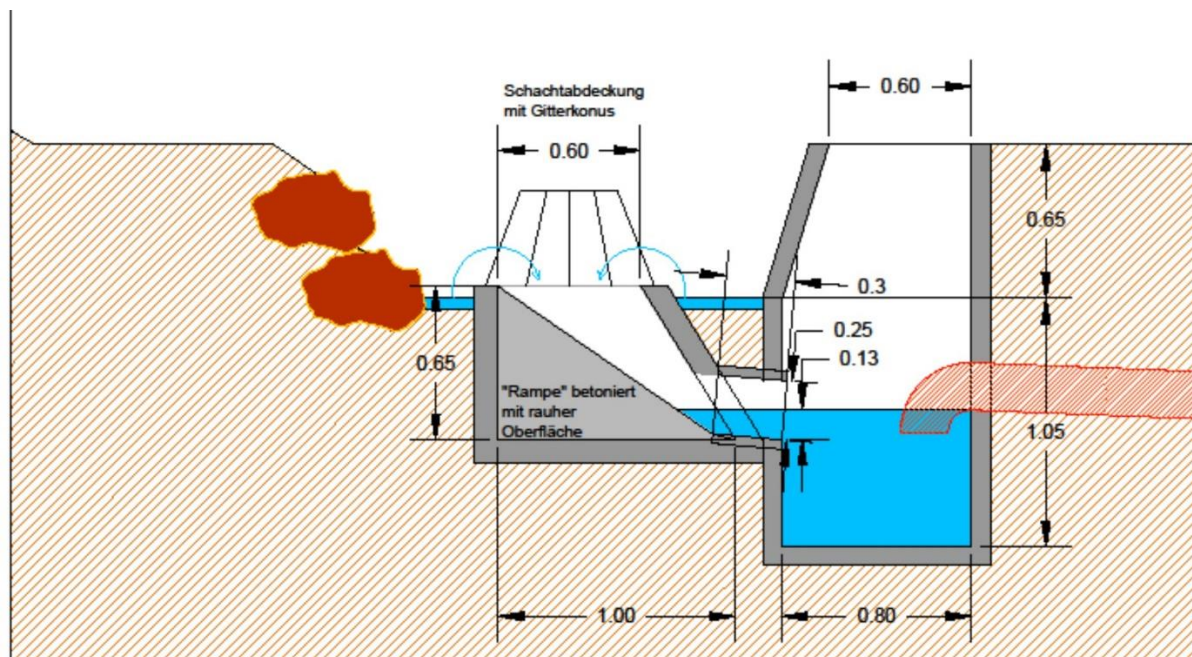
Schnitt durch den Amphibienschonenden Einleitungsschacht mit Massangaben. © GeoplanTeam
